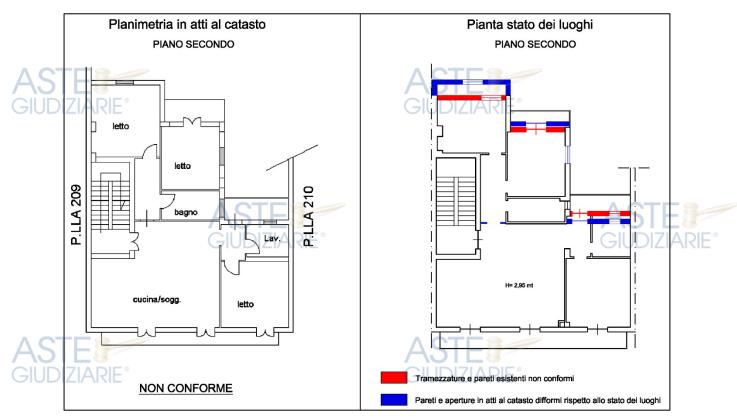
Confronto delle Planimetrie in atti al Catasto con lo stato dei luoghi
